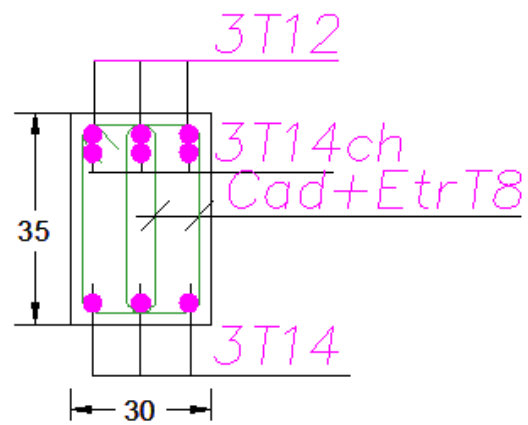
Schéma de ferrailage de la poutre secondaire.
